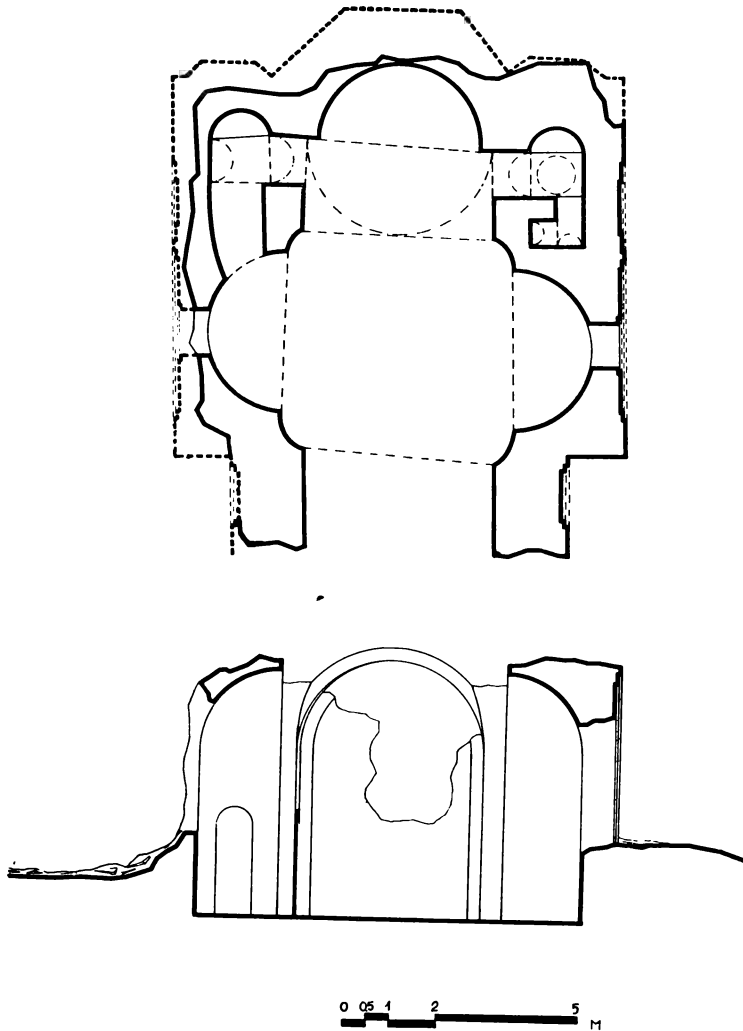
Dorf Pyle (Vineni). Hl. Nikolaskirche, Oben, Grundriss.
